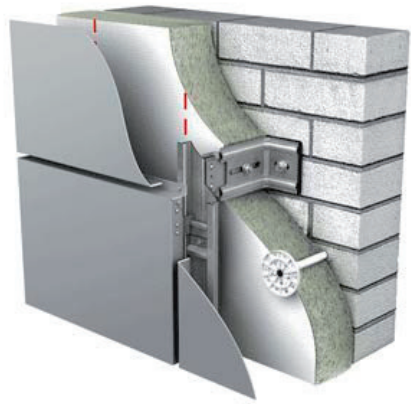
Вентильована система фасаду з утепленням ззовні.
